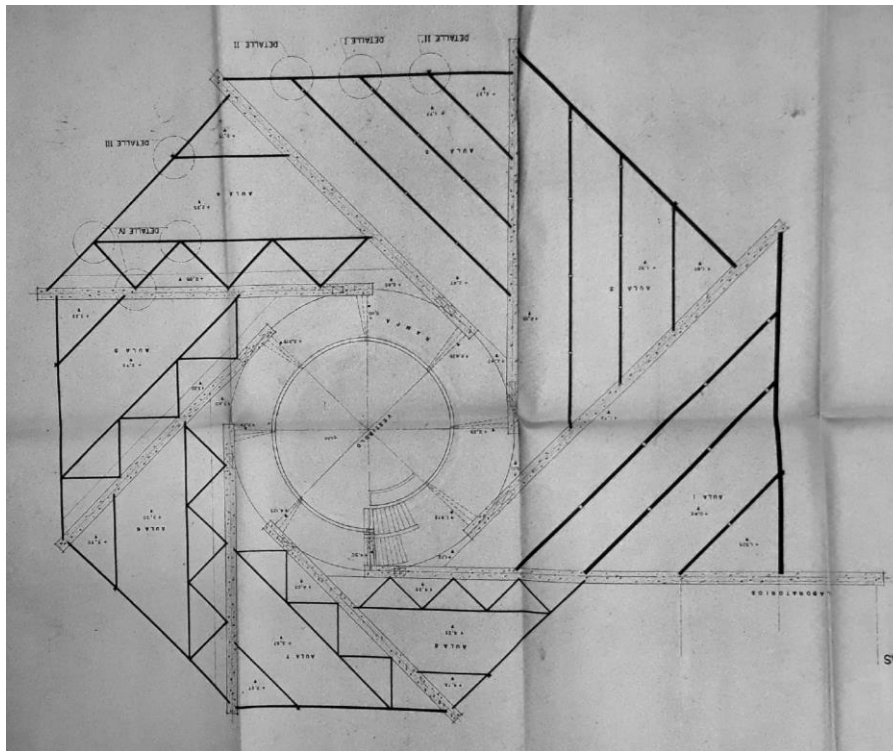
Estructura del forjado inferior de la planta alta del aulario
